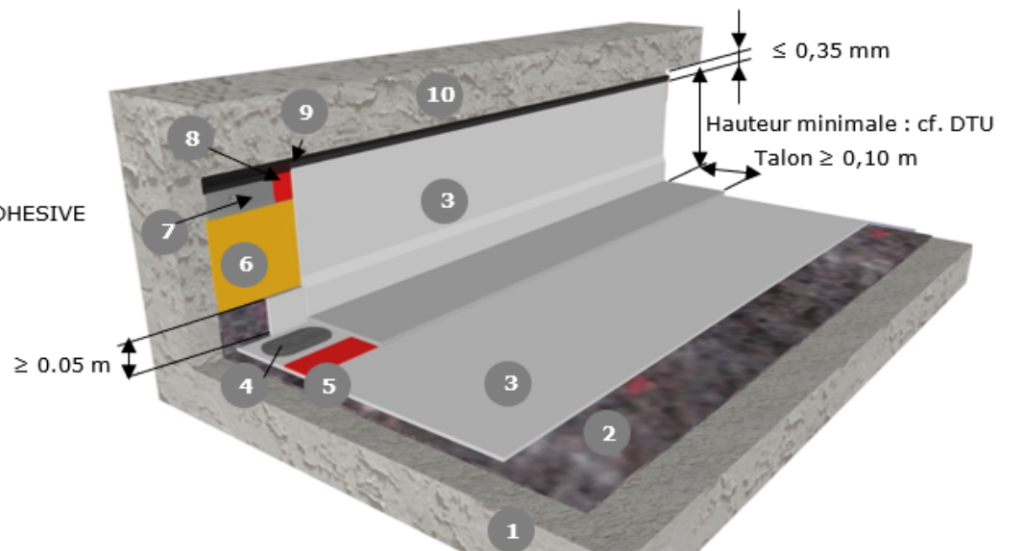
Relevés d'étanchéité avec tôle plastée (maçonnerie)
